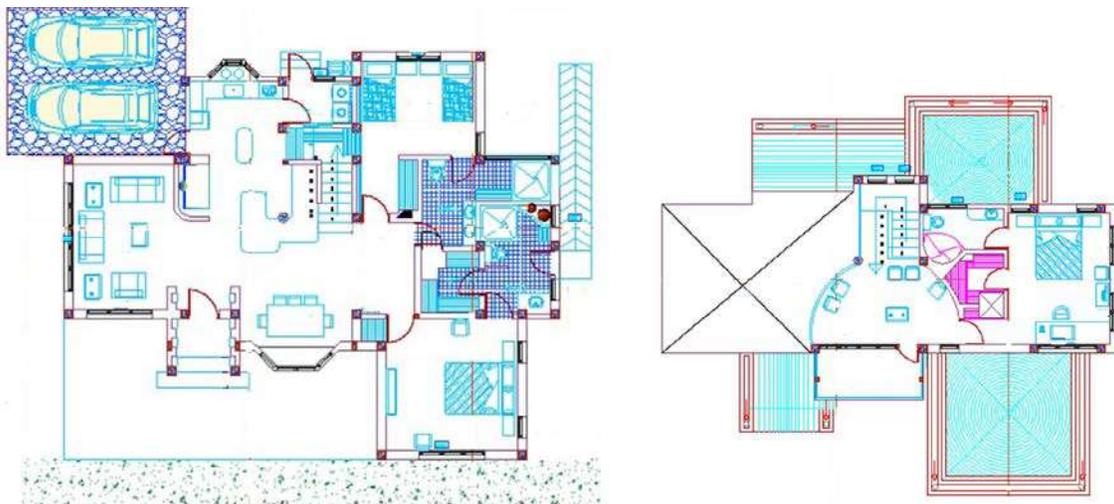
Planta arquitectonica Casa UE / primero y segundo piso
